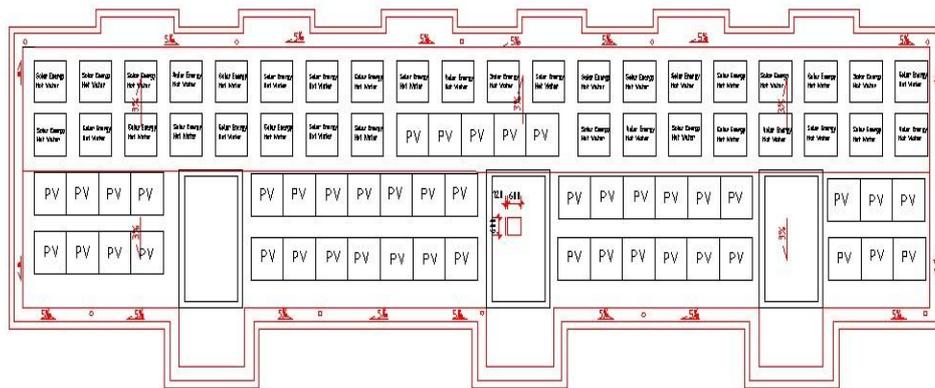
Dachaufsicht mit Dachzentralen über den Treppenhäusern und den PV- und Kollektorflächen
